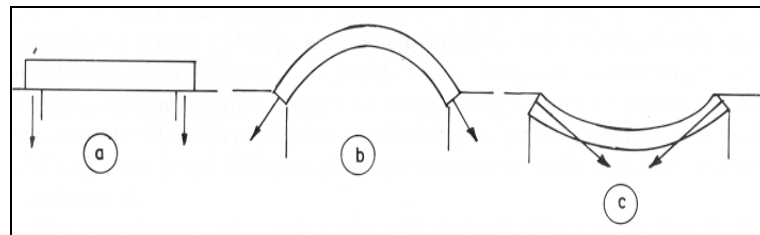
Concepto de puente (a) viga, (b) arco y (c) suspensión.
